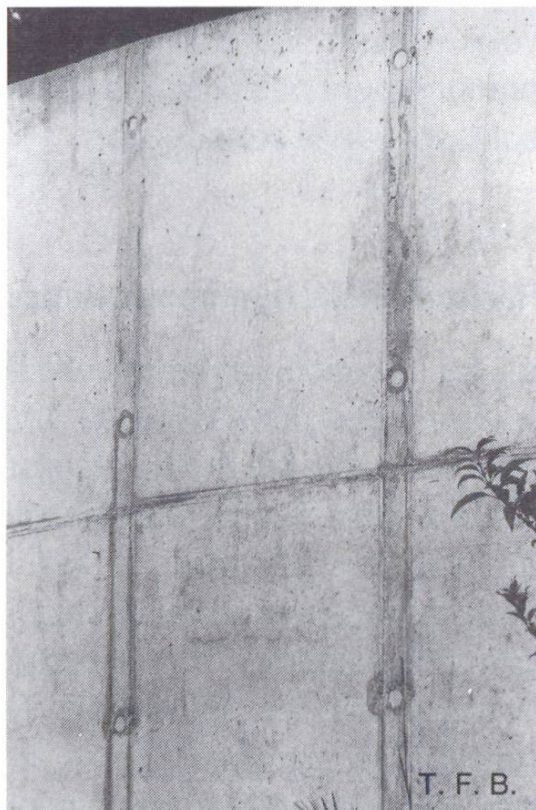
Coffrage d'une paroi avec joints étanches pour éviter les pertes de lait de ciment.
